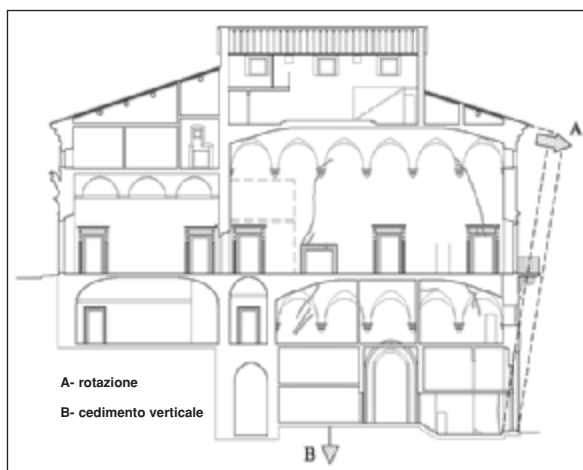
Sezione mediana Nord-Sud, rotazione della parete perimetrale Sud e cedimento verticale.
